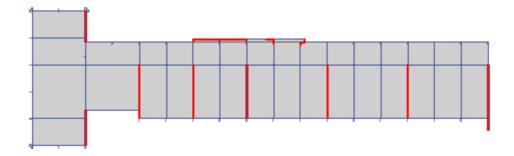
Planta segundo piso, Escuela Unión Latinoamericana Edificio 2.
